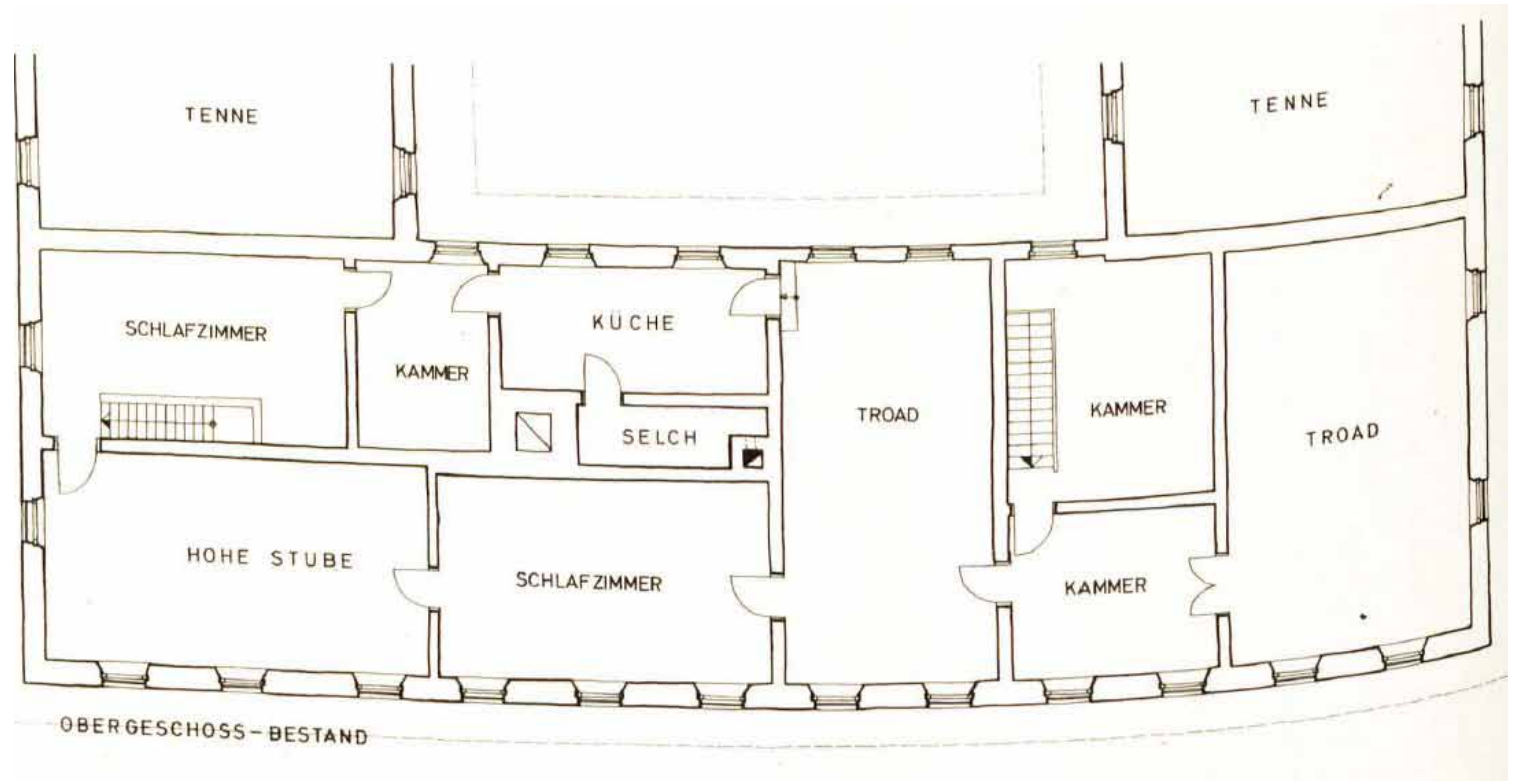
Grundriss Vierkanthof OG (Spielhofer 1981, S.80)
